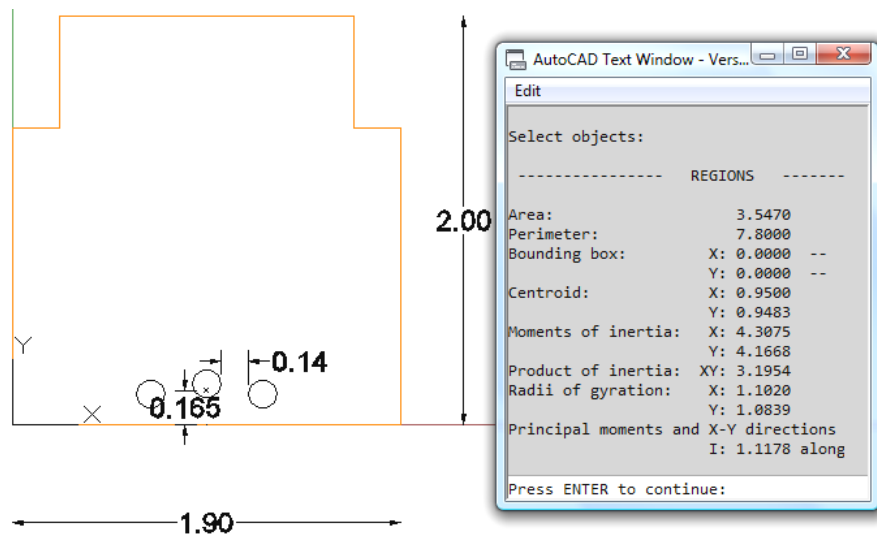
Características da secção transversal a 7,4m do apoio esquerdo
